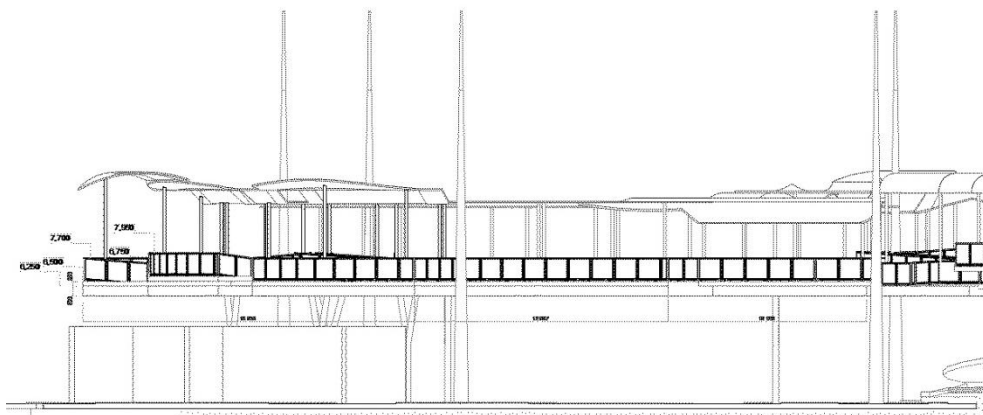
Фасад пешеходного моста. Фрагмент над автомобильной дорогой
